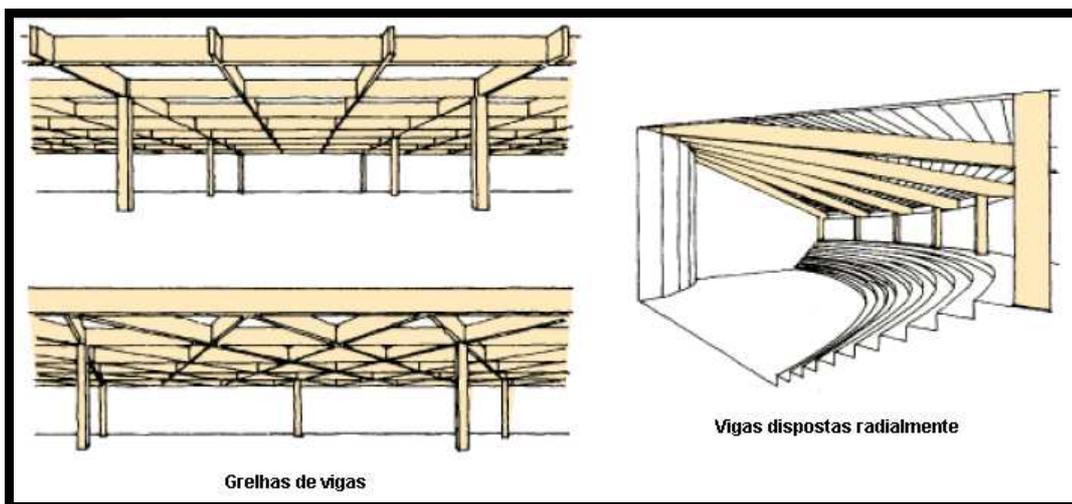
Exemplos de sistemas tridimensionais com vigas
